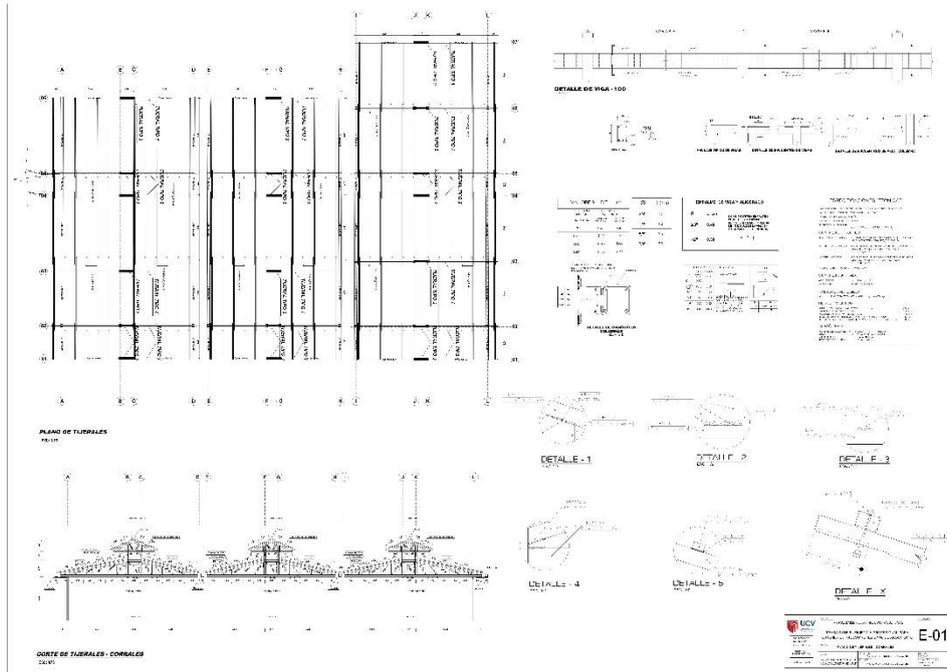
Plano de estructura de tijerales en zona de Corrales
